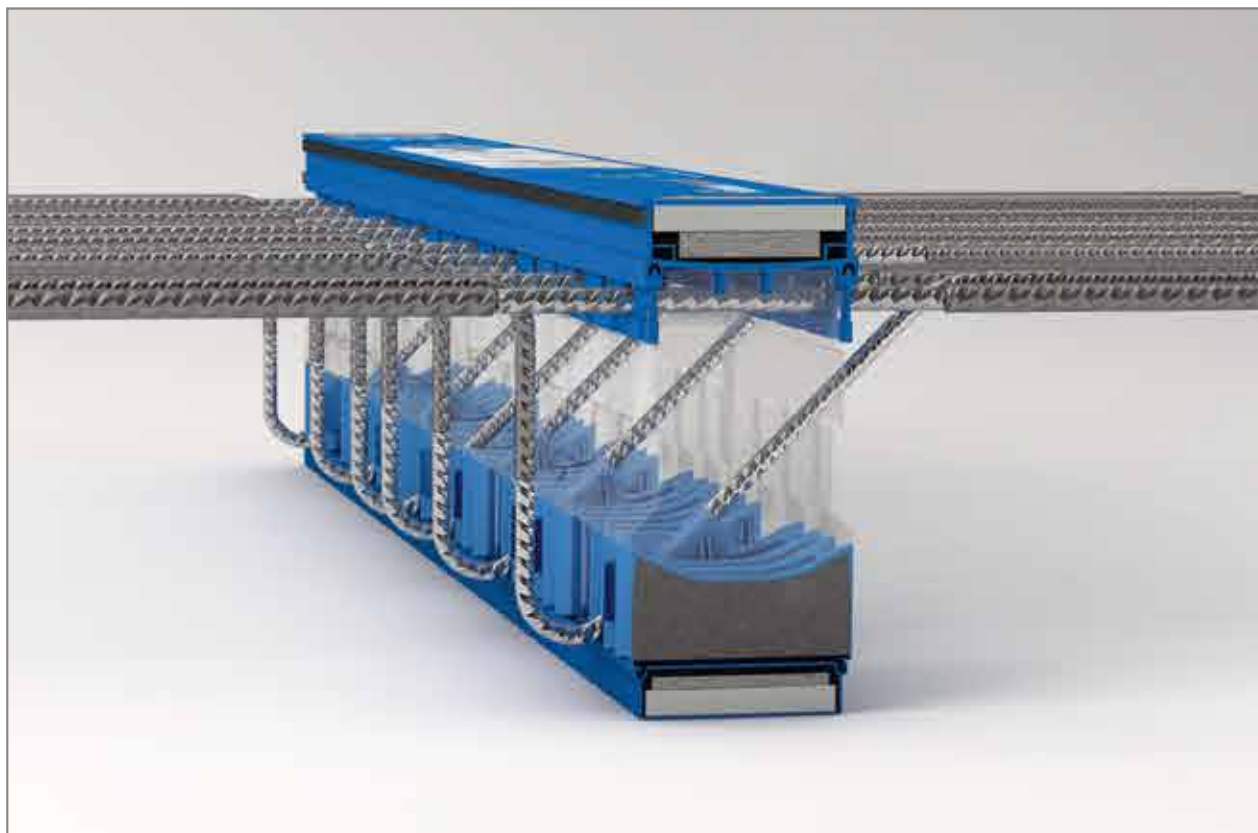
Schöck Isokorb® T typ KL: Komponenty
